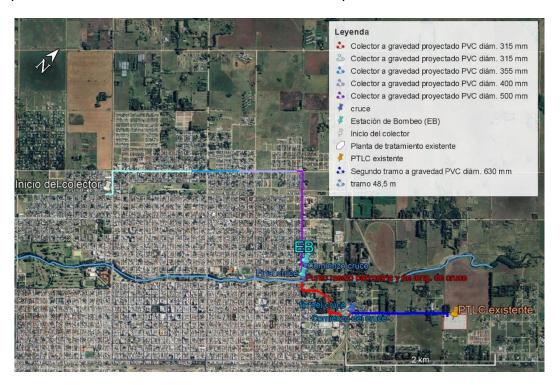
Ubicación de la estación elevadora y cañerías a construir.
